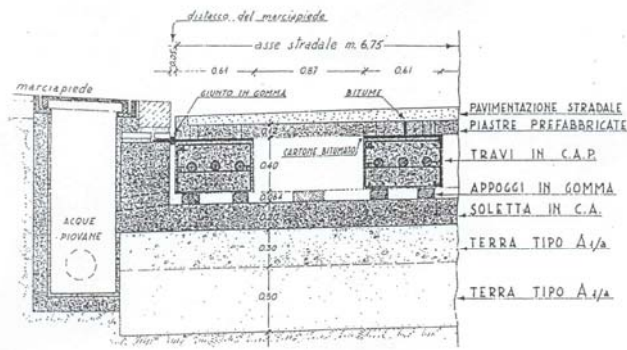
Pavimentazione realizzata nel 1970 per la protezione del palazzo della Farnesina
